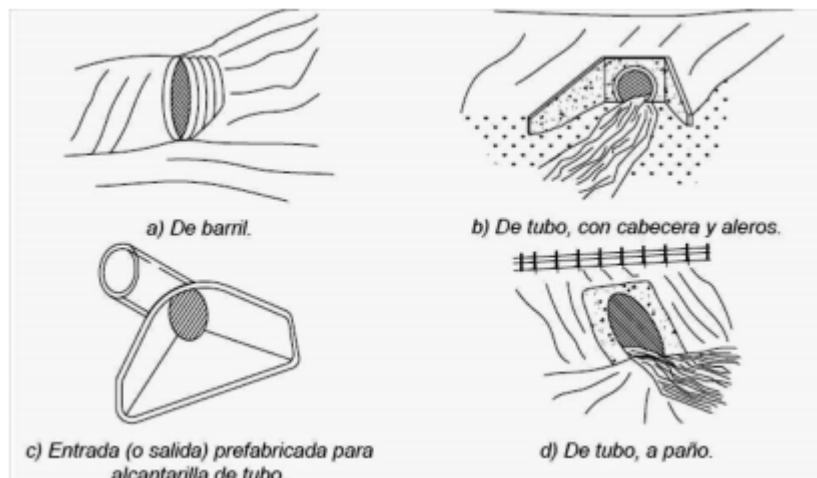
Alcantarillas pluviales. Fuente: Partes Específicas del Sistema de Alcantarillado de Aguas Lluvias, Ponencia de Abastecimiento de Agua y Alcantarillado, año 2009.
